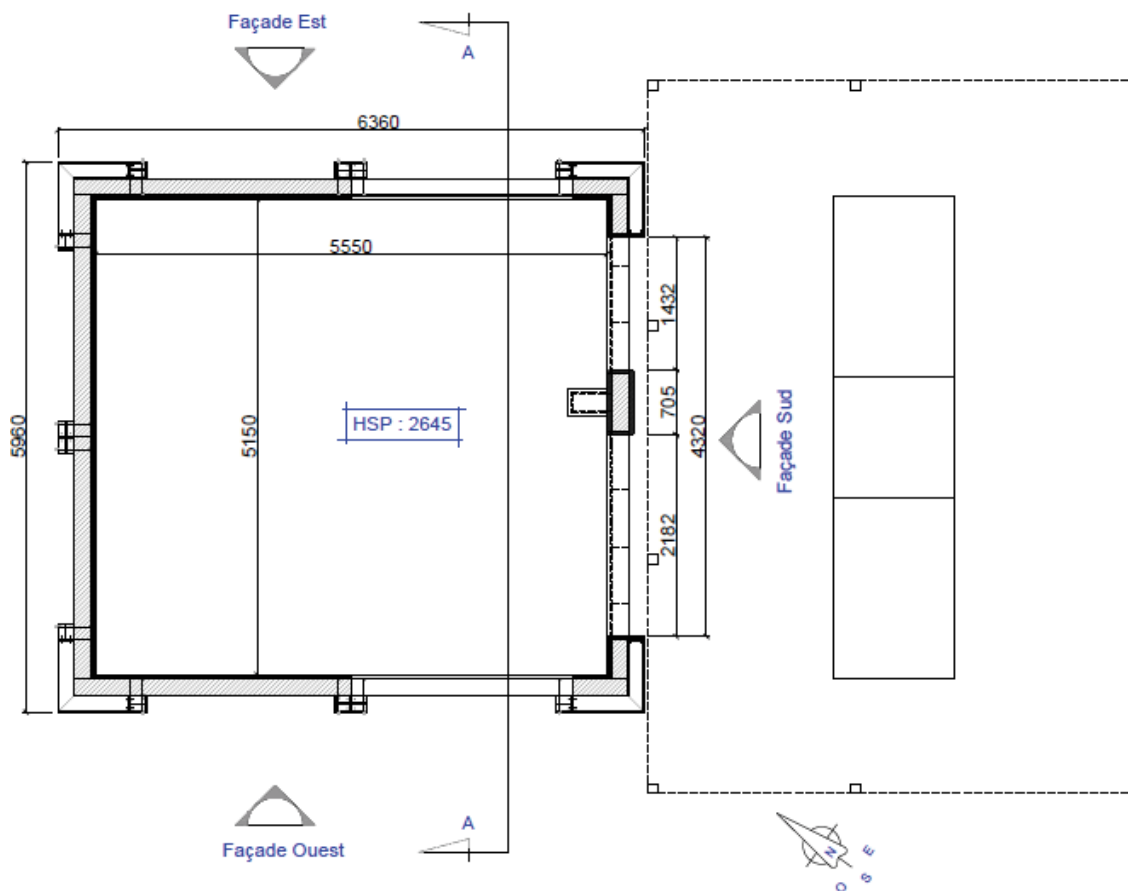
Vue en plan de la cellule d'essai pour les essais 2 et 4 (Plafond CLT)
